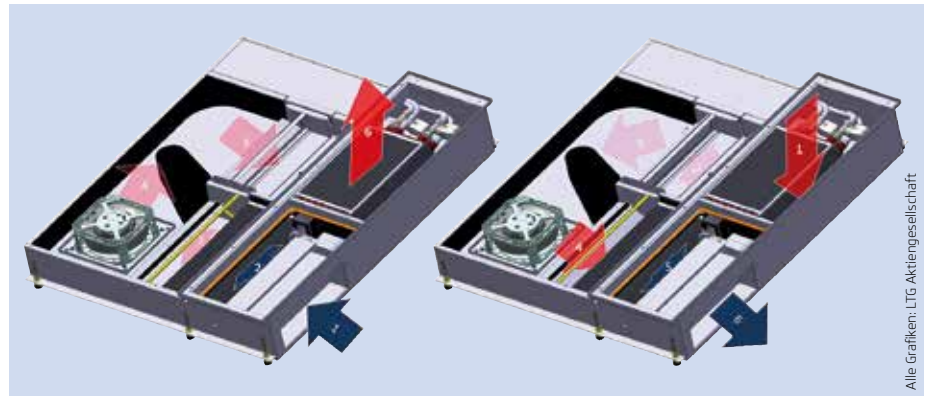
Aufbau des Fassadenlüftungsgerätes: a) beim „Einatmen“ werden nacheinander durchströmt: Frischluftklappe – Wärmerückgewinnung – saugseitige Klappe zur Strömungsumkehr – EC-Ventilator – druckseitige Klappe zur Strömungsumkehr – Wärmeübertrager b) beim „Ausatmen“: Wärmetauscherbypass – saugseitige Klappe zur Strömungsumkehr – EC-Ventilator – druckseitige Klappe zur Strömungsumkehr – Wärmerückgewinner – Frischluftklappe
